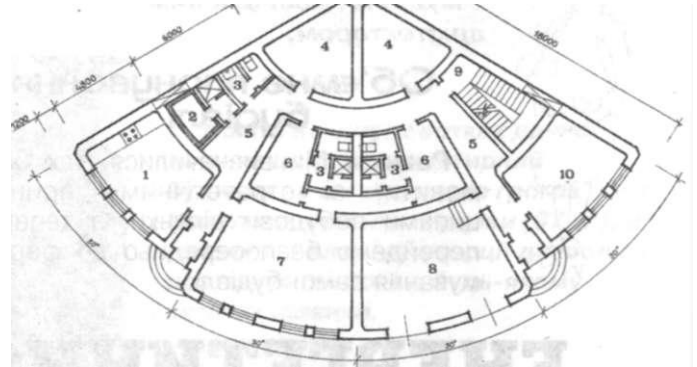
План першого поверху ярусної житлої будівлі: 1 – кухня; 2 – сауна; 3 – санітарний вузол; 4 – комора; 5 – коридор; 6 – роздягальня тренажерної зали; 7 – тренажерна зала; 8 – гараж; 9 – сходові клітка; 10 – кабінет
